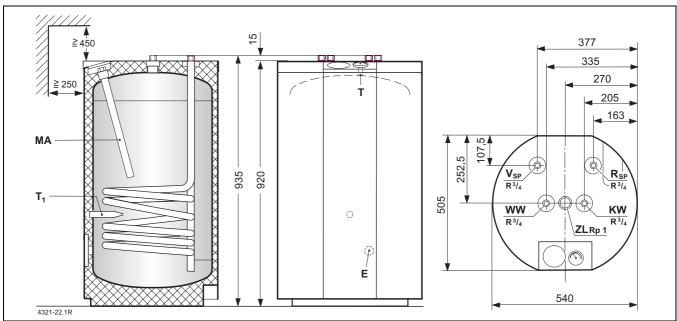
Bau- und Anschlussmaße ST 120-1 Z
